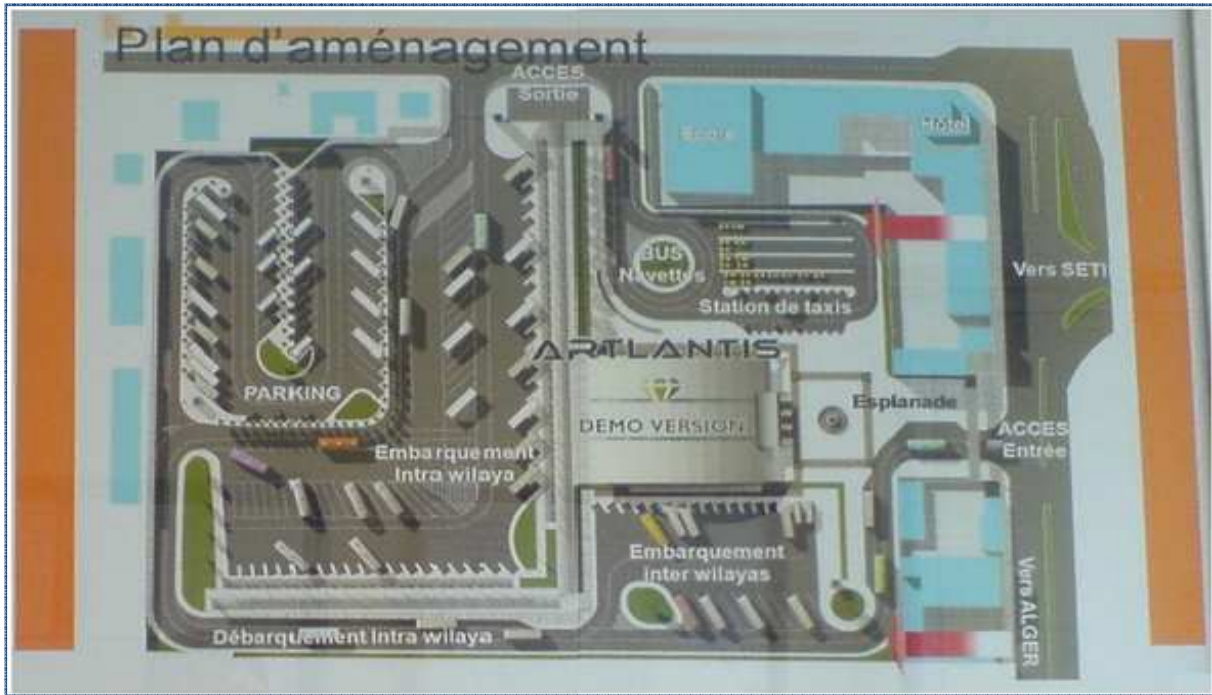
Plan d'aménagement de la nouvelle gare routière
